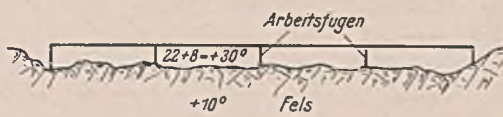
Betonieren auf der Grundfuge bei Sperrmauern.
